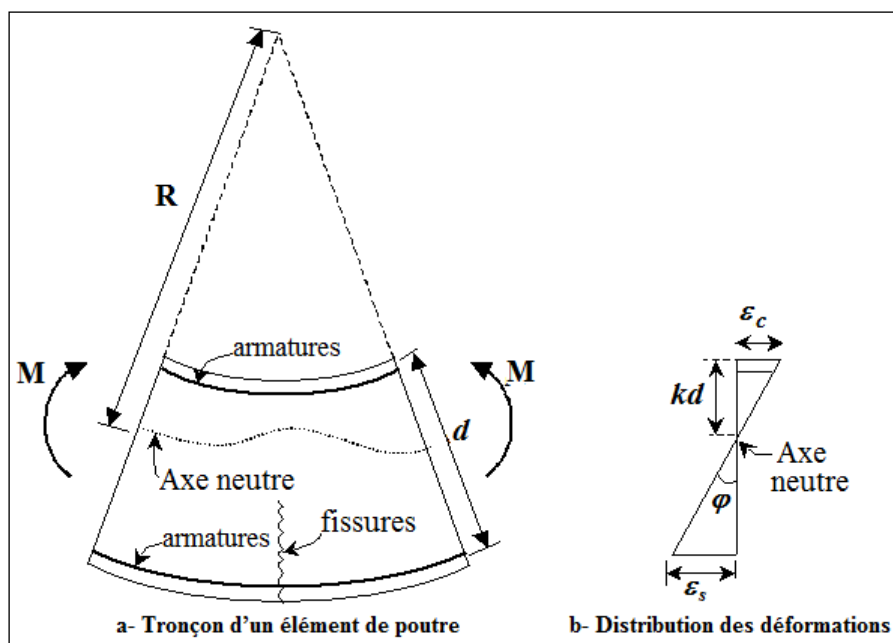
Déformation d'une poutre fléchie en béton armé (Park et Paulay (1975)).
